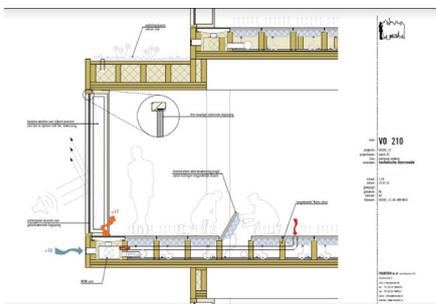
Particolare Pavimenti Sopraelevati, sezione. In: <https://archello.com/project/patch22>
